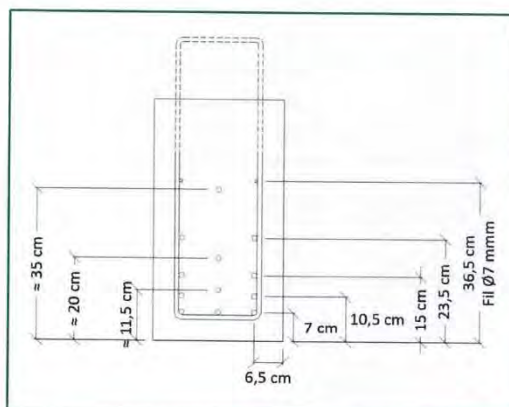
Ferrailage des poutres issus des reconnaissances in-situ
